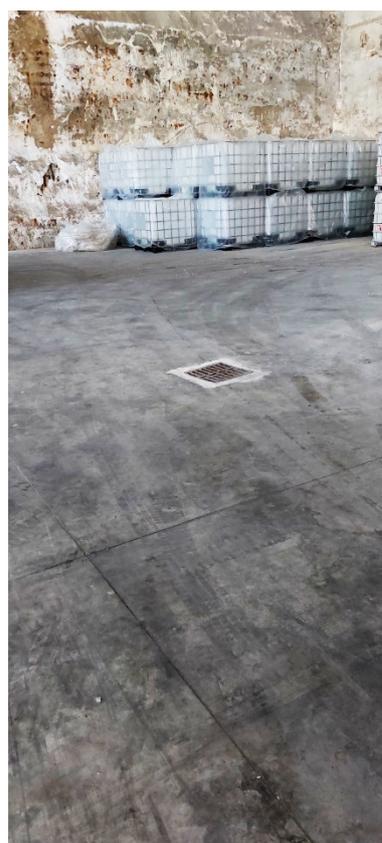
, FOTO 2, FOTO 3: ACQUE DI LAVAGGIO IN ATTESA DI CARATTERIZZAZIONE E IN DEPOSITO; POZZETTO CIECO DI RACCOLTA SVERSAMENTI.
